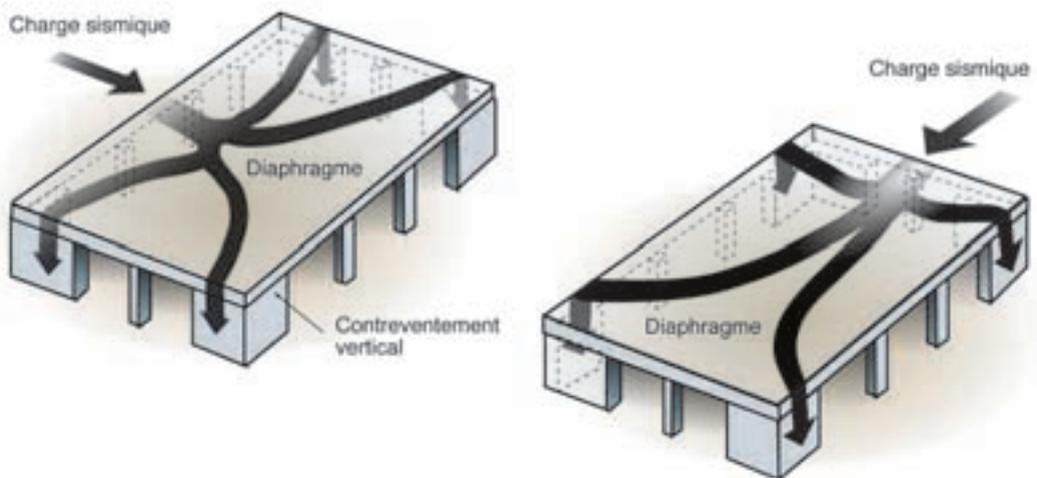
Contreventement d'un niveau : plancher rigide formant un diaphragme, associé à des murs de contreventement
